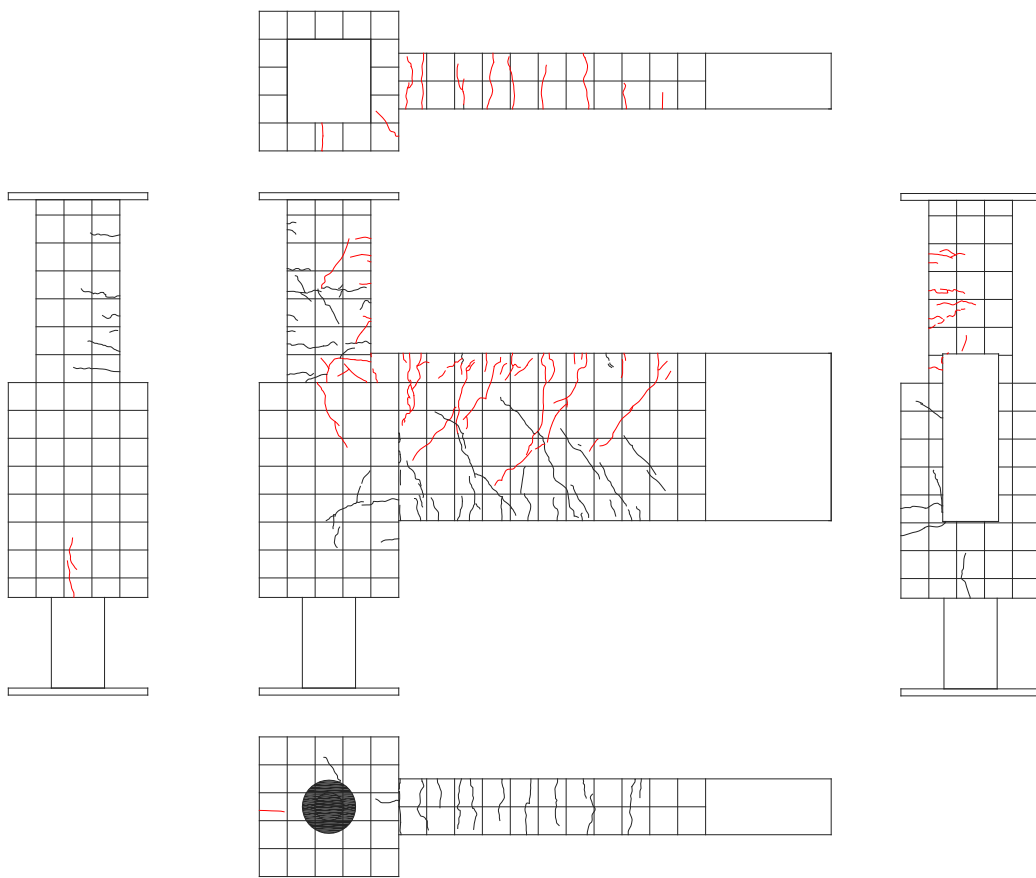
試験体 A-6 ひび割れ状況 (4Cycle)
